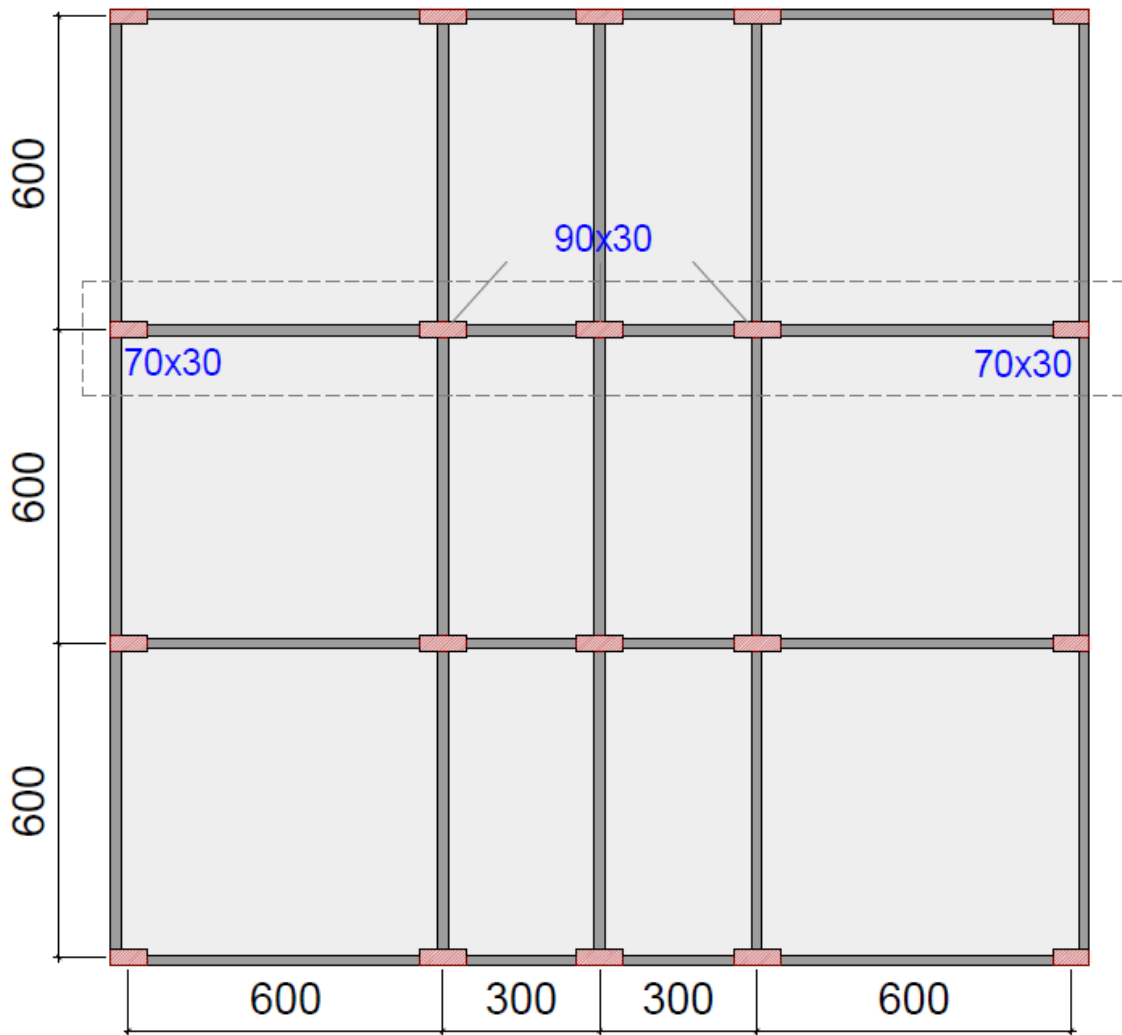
Pórtico plano de 20 pavimentos e 4 vãos: seleção na planta do pavimento tipo.
